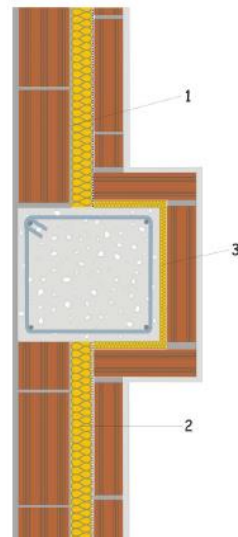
Encuentro con pilar.Corrección de puente térmico en pilar
